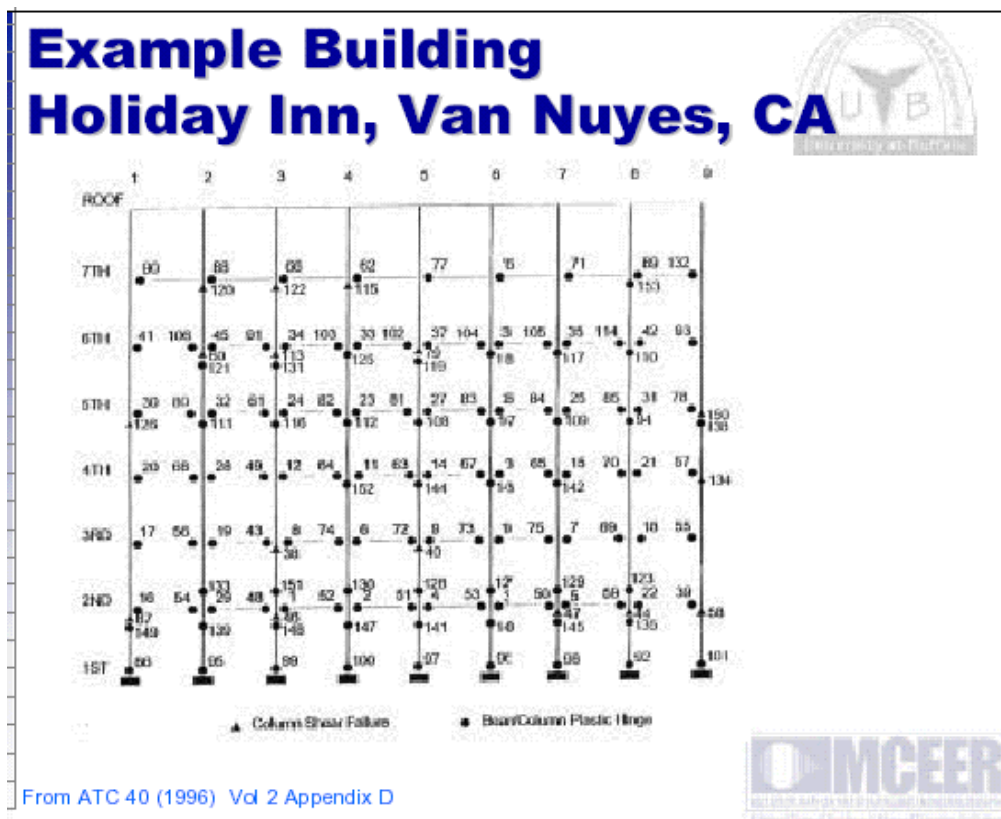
Formación de rótulas plásticas en vigas y columnas en el pórtico.
